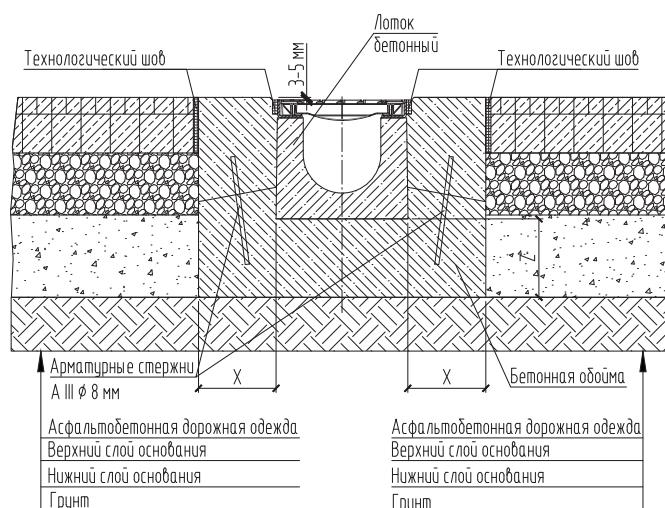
Пример обоймы бетонного лотка для класса нагрузки от D400 до Е600 с прилегающим покрытием «асфальтобетонной дорожной одежды».
